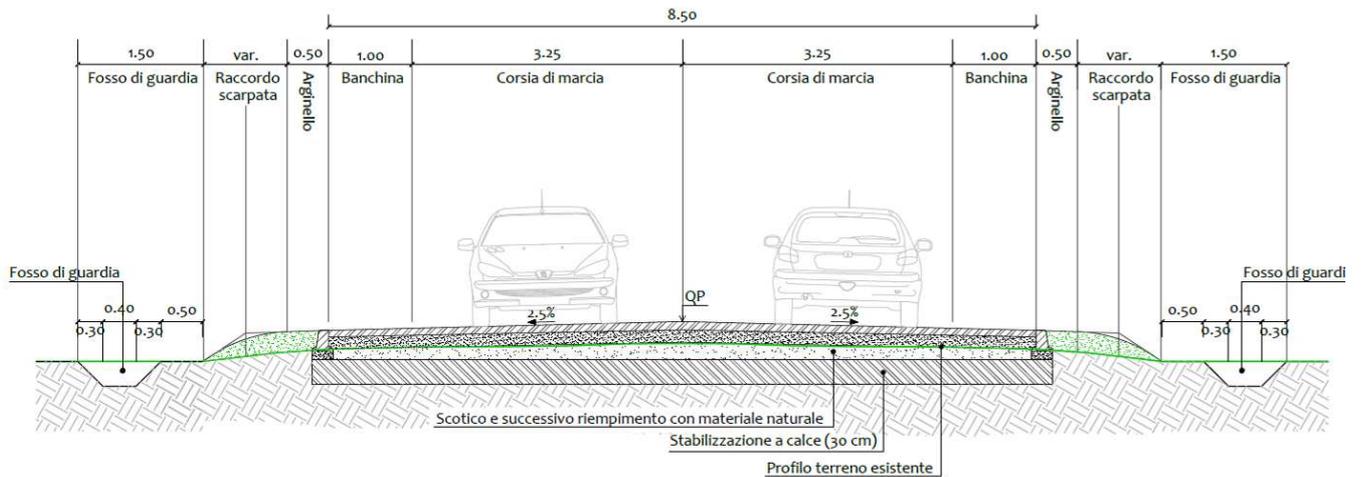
Sezione tipologica 1 e pacchetto di pavimentazione della pista di cantiere
